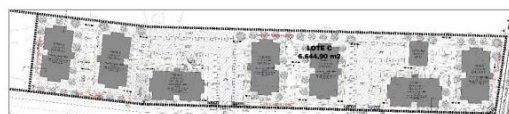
Plano planta – Lote C. Vivienda Vivir Mejor
